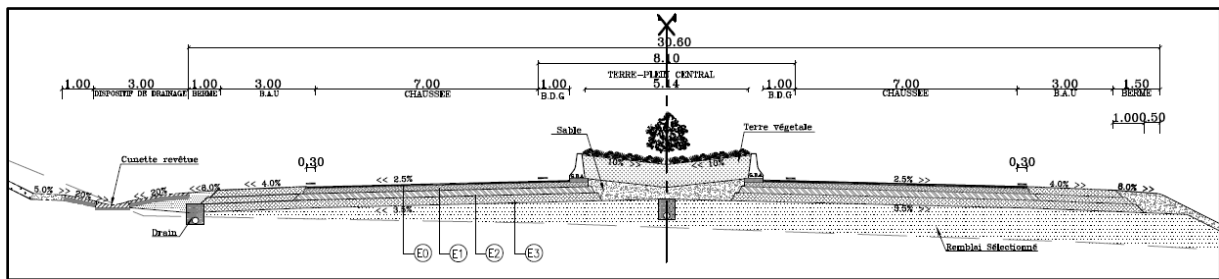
Profil en travers type proposé en relief difficile – Section courante
